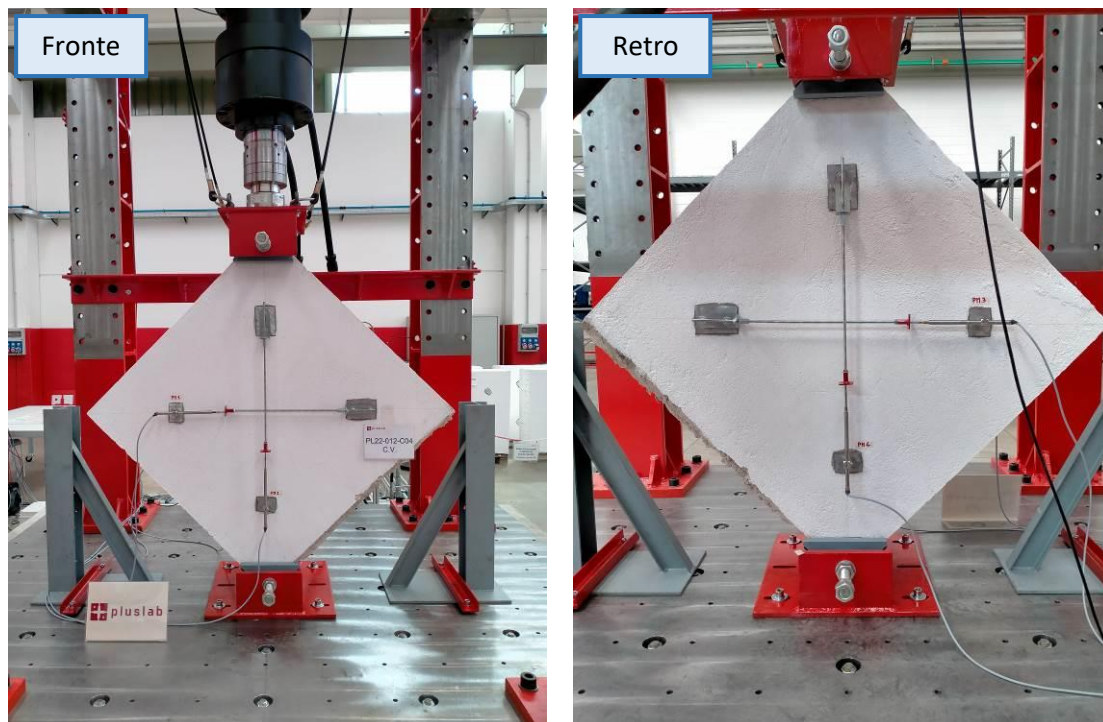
Campione C03 – CALCEVITA STRUTTURALE prima della prova
